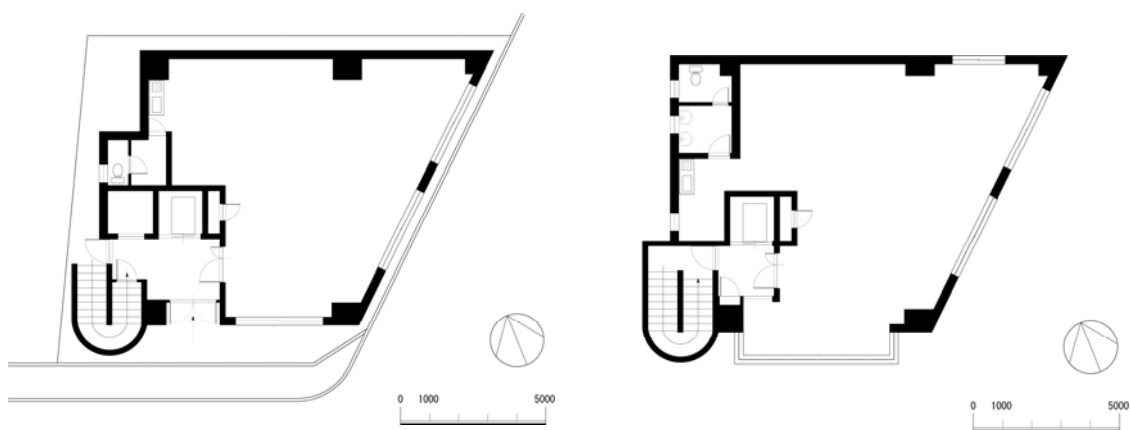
『ハッピースクウェア』平面図（左：1F平面、右：2F平面）
